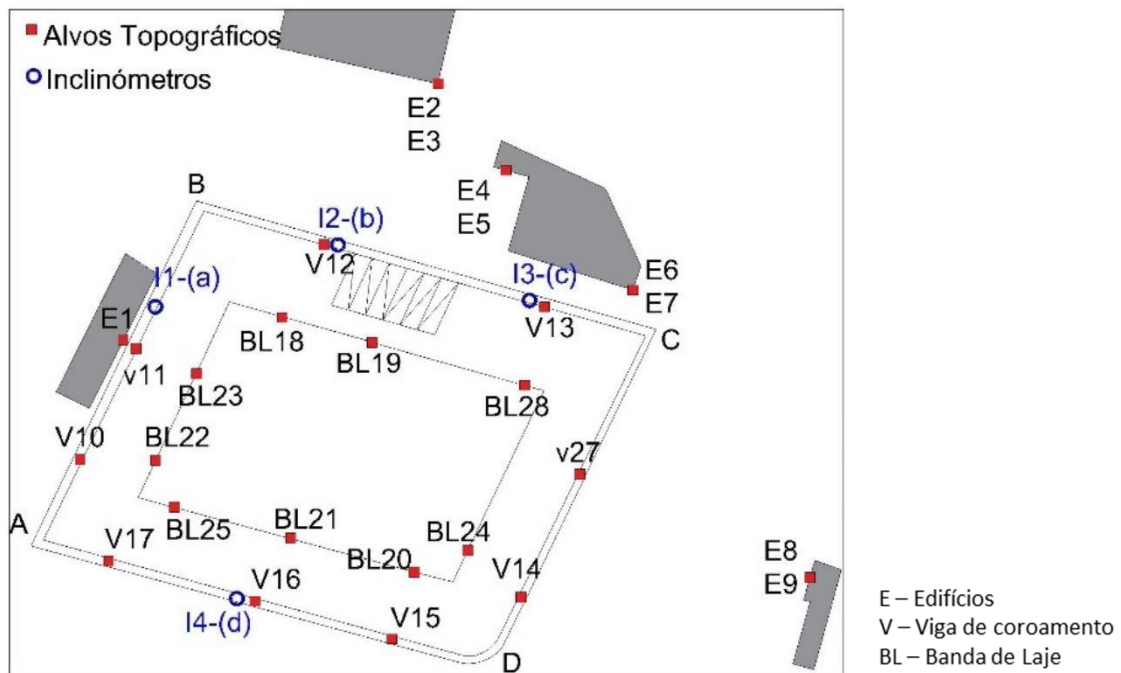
Planta de Instrumentação. (Fonte: Issufo, 2016)
